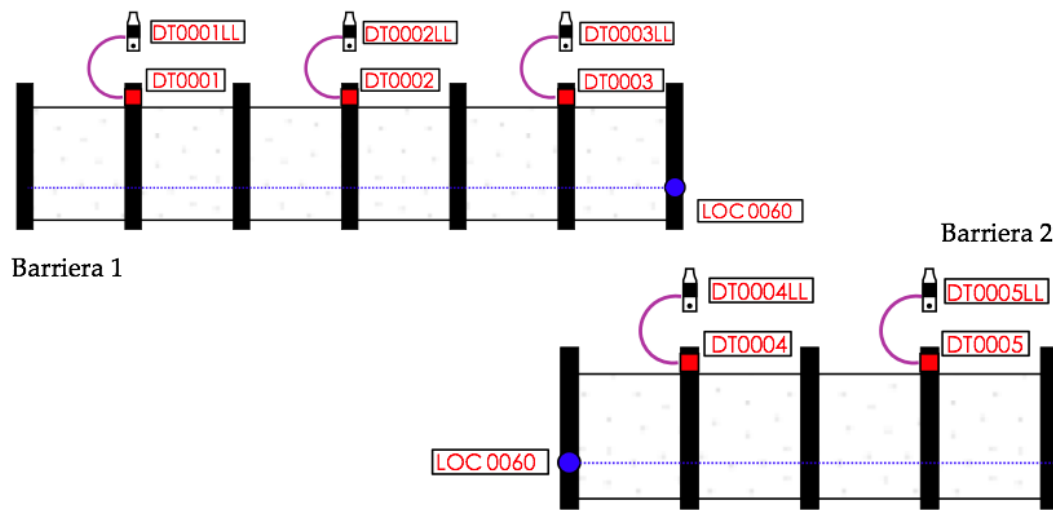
Disposizione degli strumenti di monitoraggio prototipali sulle barriere paramassi collocate nel cantiere Monte Cingolo.
